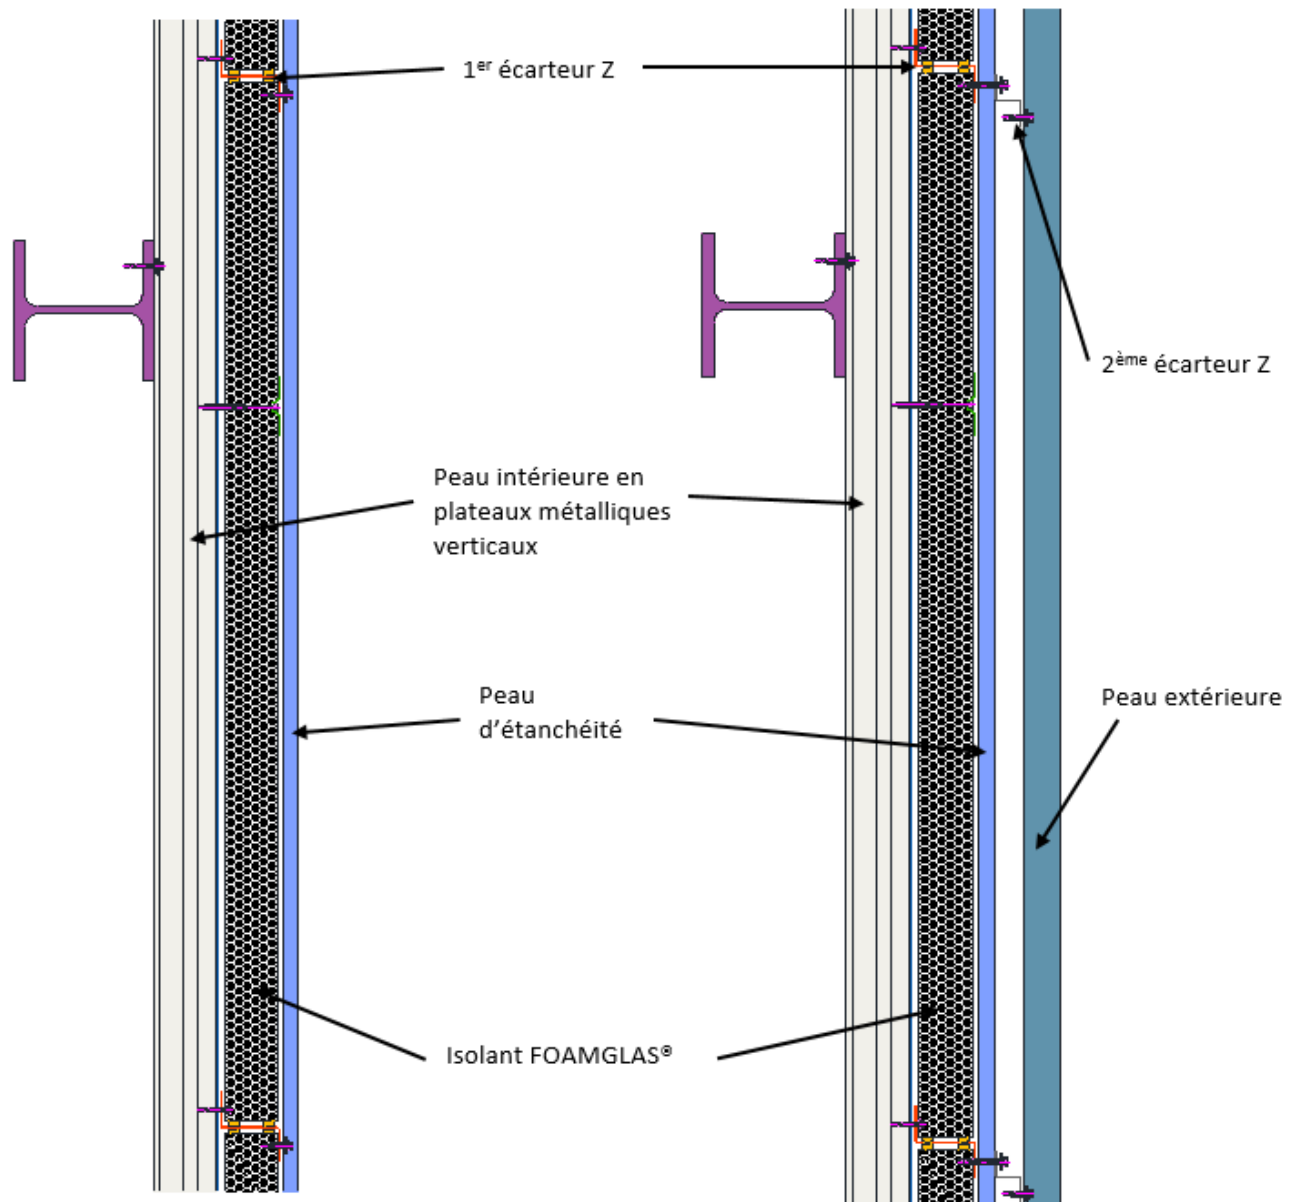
Vue en coupe verticale d'exemples de systèmes double peaux ou triple peau
